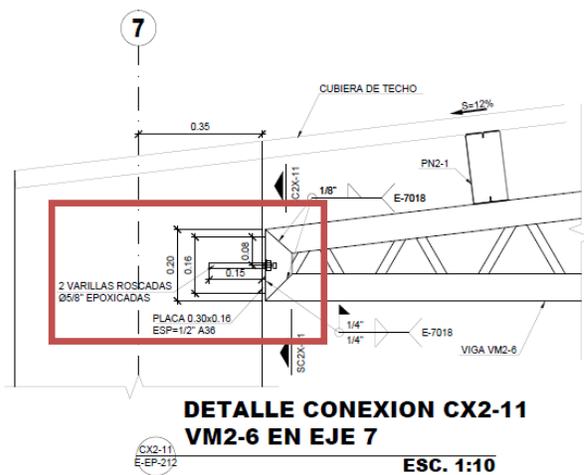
COMPARACIÓN ENTRE DETALLE DE CONEXIÓN METÁLICA
